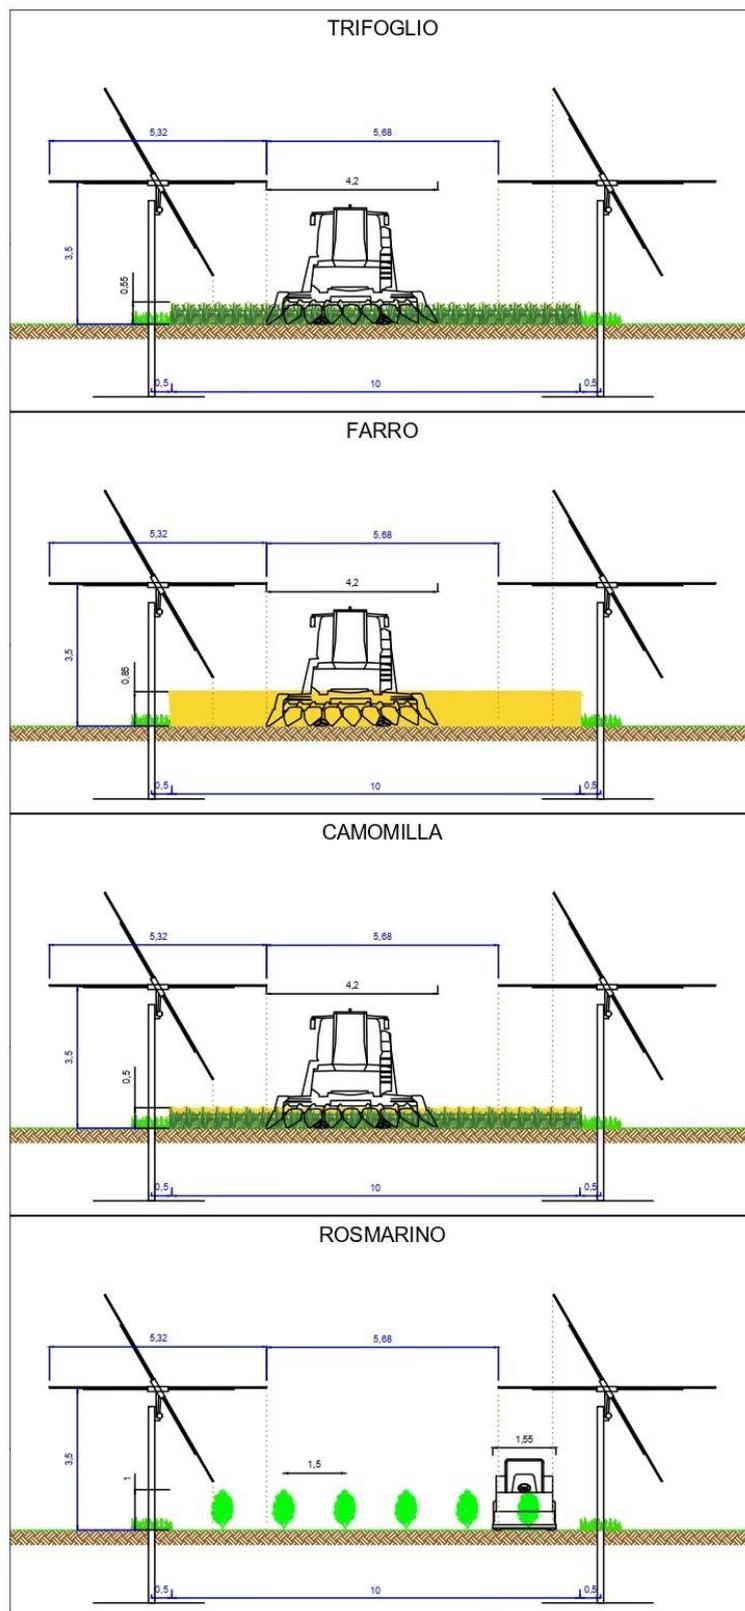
Rappresentazione del prospetto frontale delle colture
